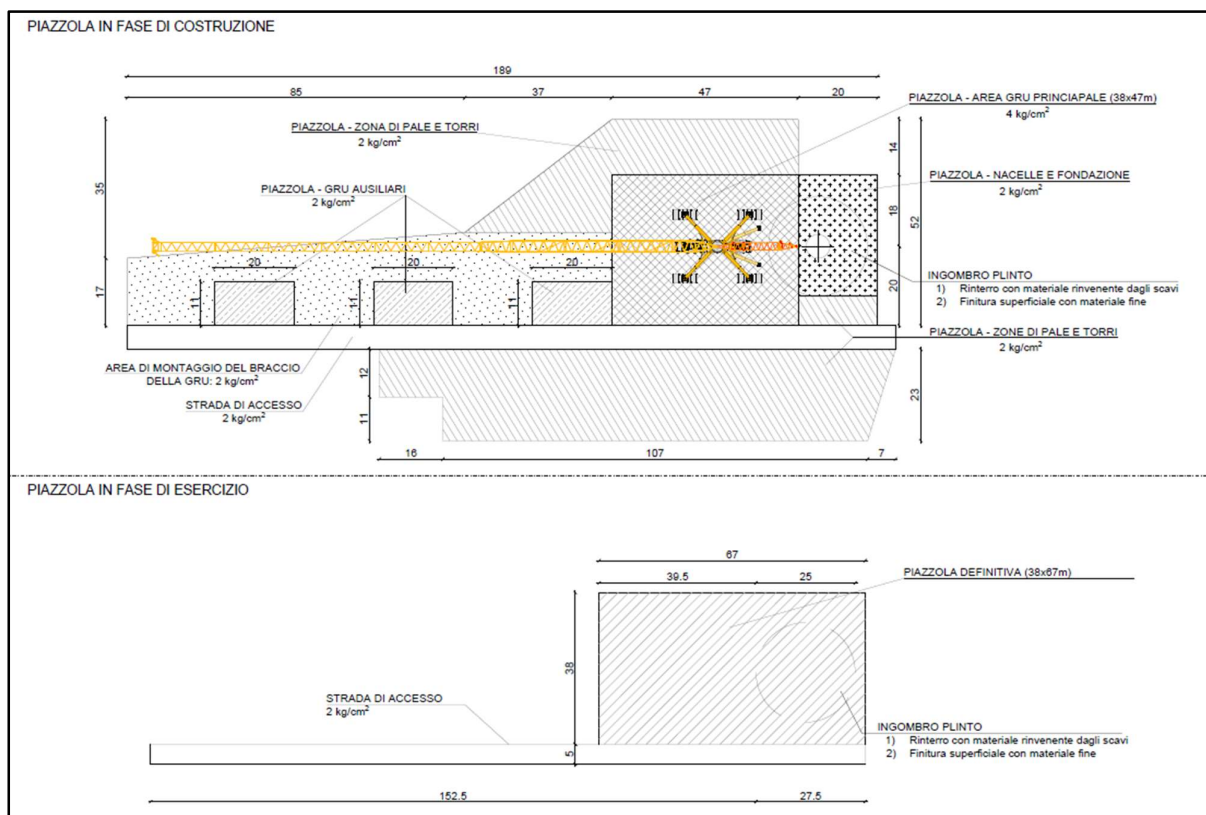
Planimetria piazzola tipo per la fase di installazione e fase di esercizio e manutenzione
